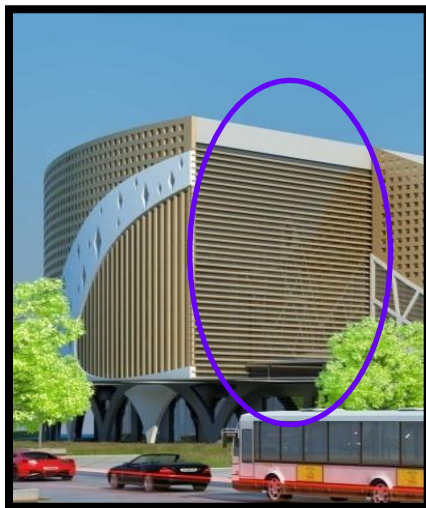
Vue du projet sur la façade Sud. Source : Auteur.
